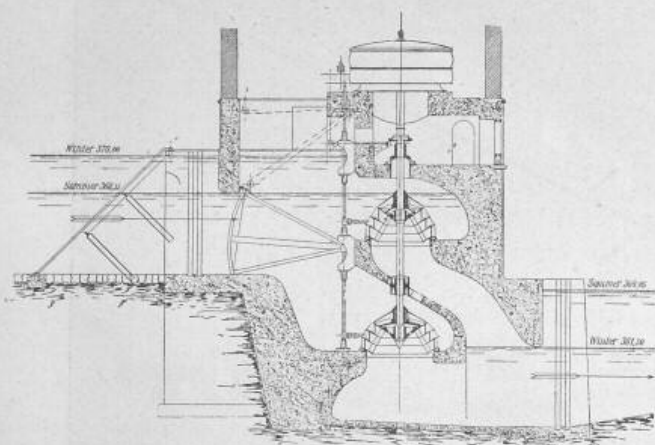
Turbinenanlage älterer Ausführung. 1:300.
